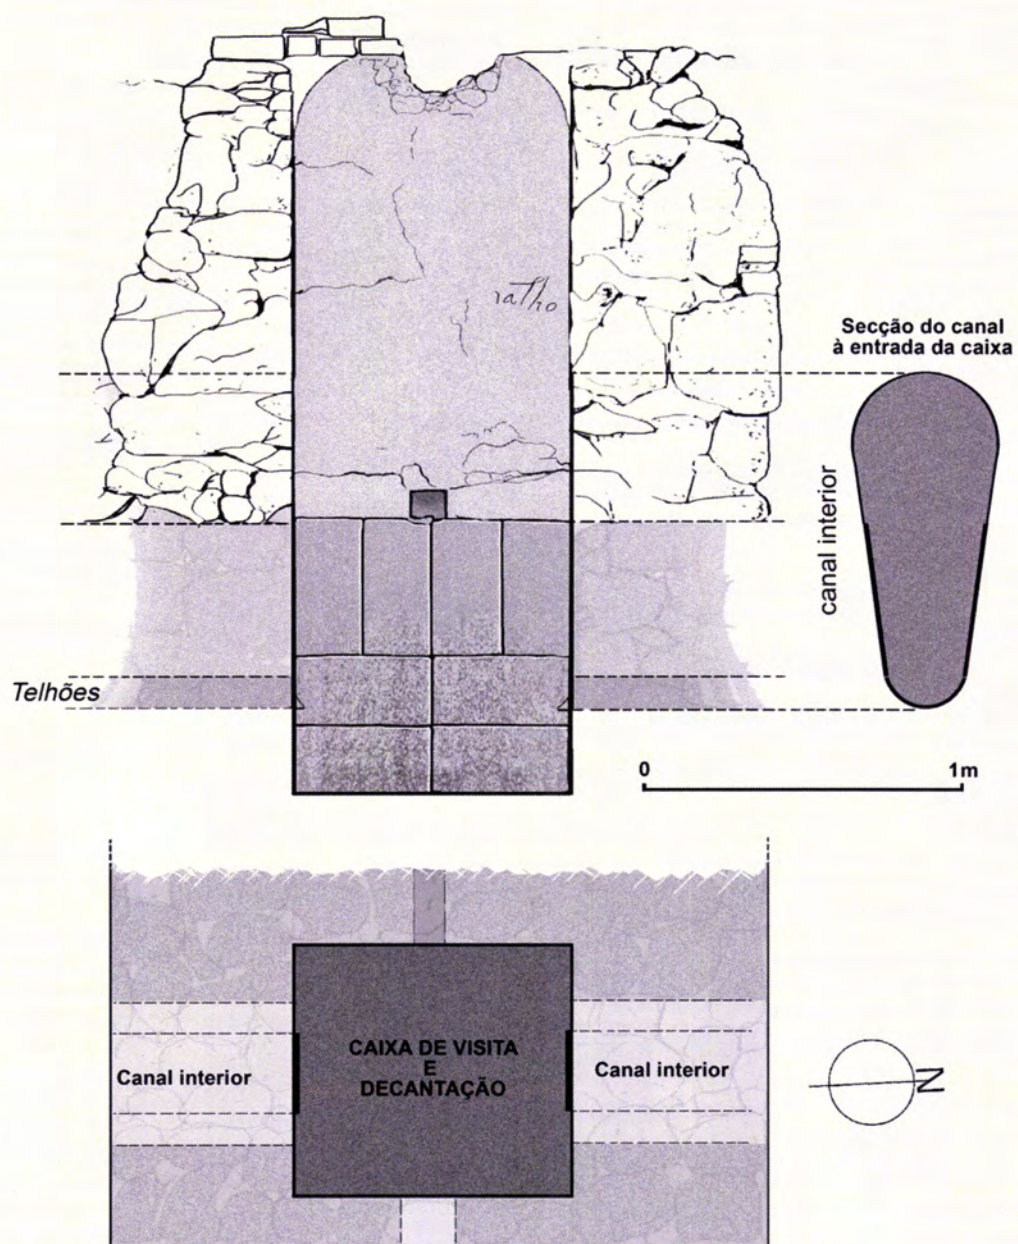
Alçado e planta da caixa de visita e decantação de Metrogos. Estrutura original do séc. XVI.
